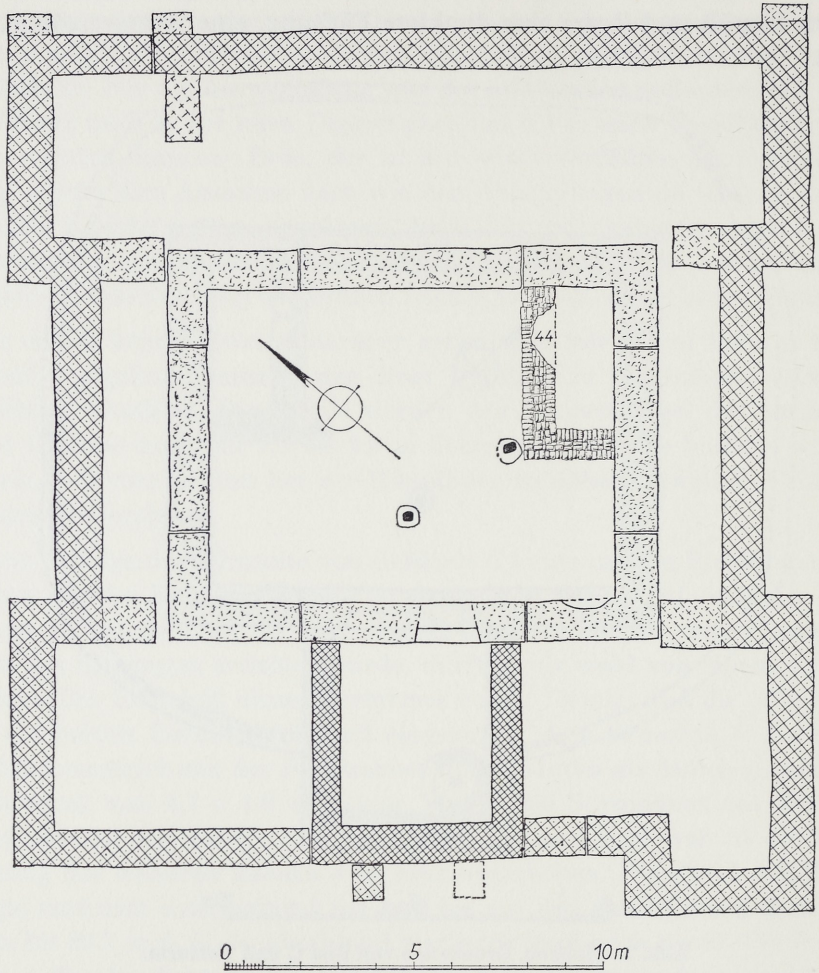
Holtrop. Grundrisse von Bau C, Torturm und Wehrmauer.
